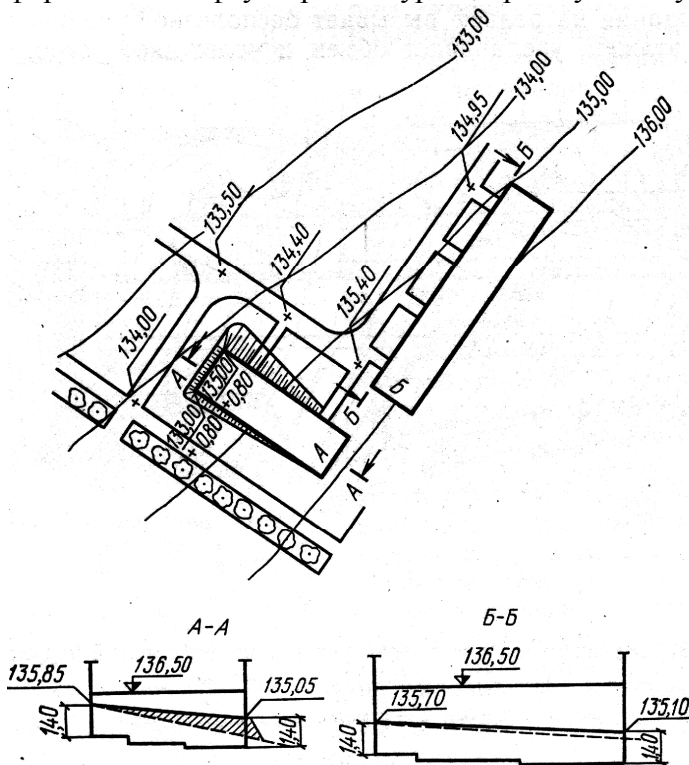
Схема вертикального планування групи житлових будинків. План і розрізи: А – вертикальне розташування будинків поперек горизонталі; Б – паралельне розташування будинків вздовж горизонталі.
